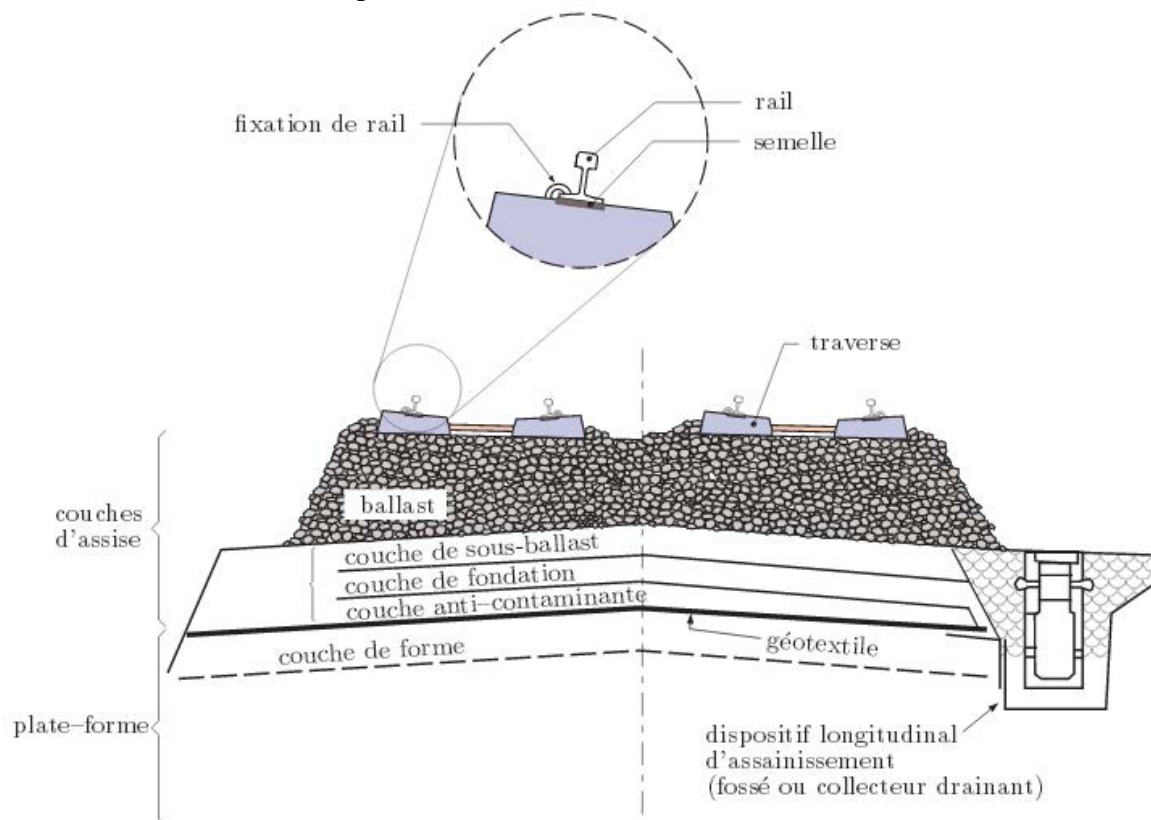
Structure d'une plateforme ferroviaire [KOU 09]
